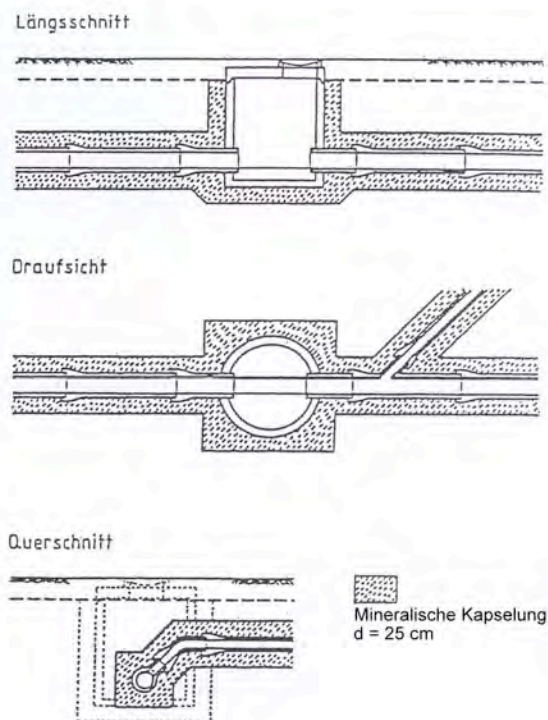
Haltung mit Kontrollschacht und Hausanschluss
